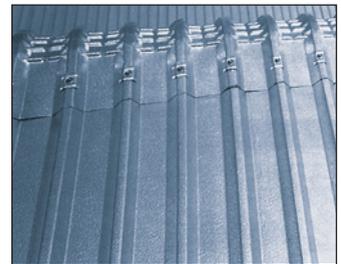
Trapezblech-Dacheindeckung aus verzinktem Blech
